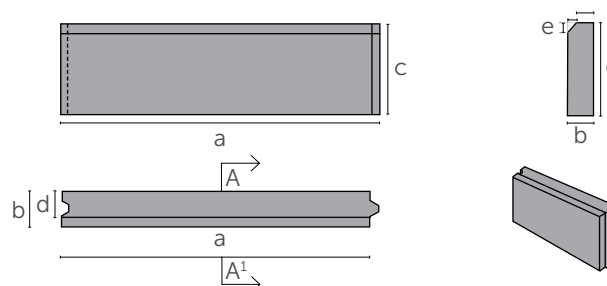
Imagen referencial de solerillas tipo B. Fuente: Elaboración propia.
